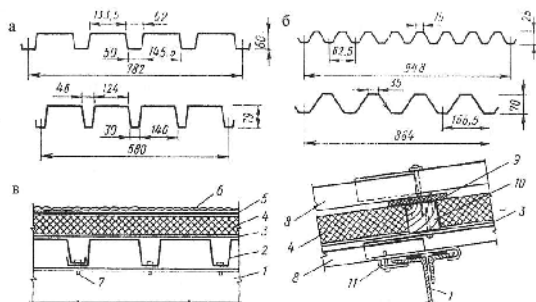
Покрытия с металлическим профилированным настилом: а — стальной настил; б — алюминиевый настил; в) — утепленное покрытие со стальным несущим настилом; г) — утепленное покрытие с алюминиевым несущим и кровельным настилами; 1 — стальной прогон; 2 — настил; 3 — пароизоляция; 4 — утеплитель; 5 — рулонный ковер; 6 — защитный слой; 7 — самонарезающий болт; 8 — настил; 9 — нащельник; 10 — деревянный брусок; 11 — приспособление для крепления изоляционных прокладок
